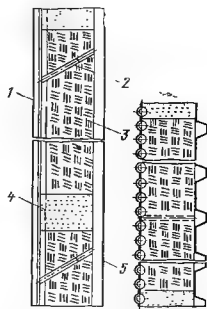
Крепление изоляции из плит на наклонных стержнях с заполнением швов напыляемой изоляцией.
